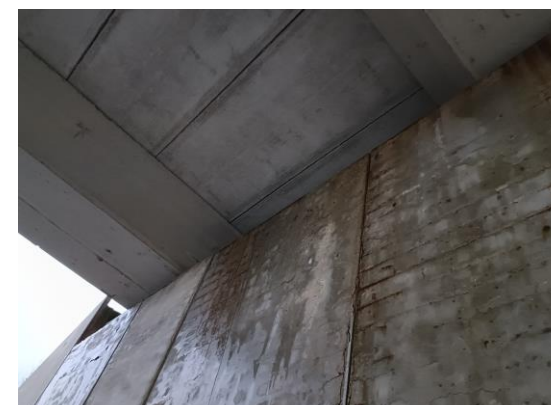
Escurrimiento de agua proveniente de plataforma por los muros del estribo 2
